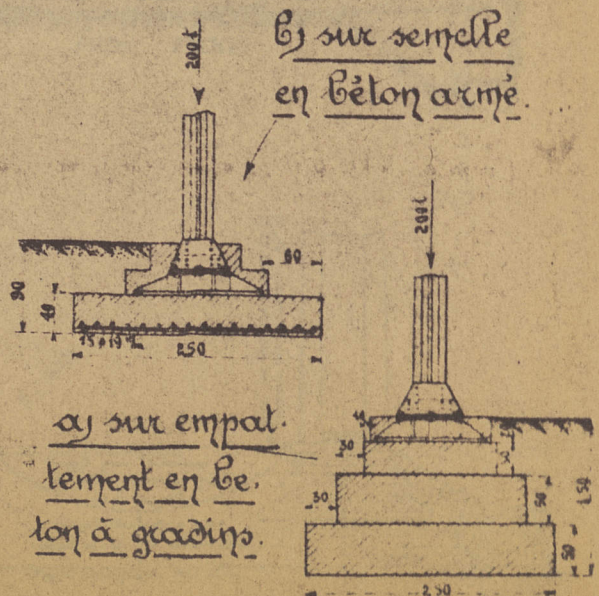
Fondation d'une colonne métallique sur cloche considérée.
